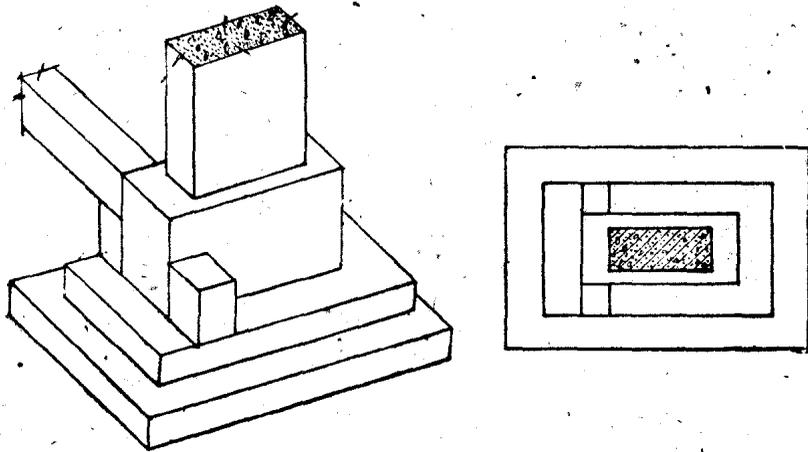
高柱靴基础上的钢筋混凝土基础梁的安放。
